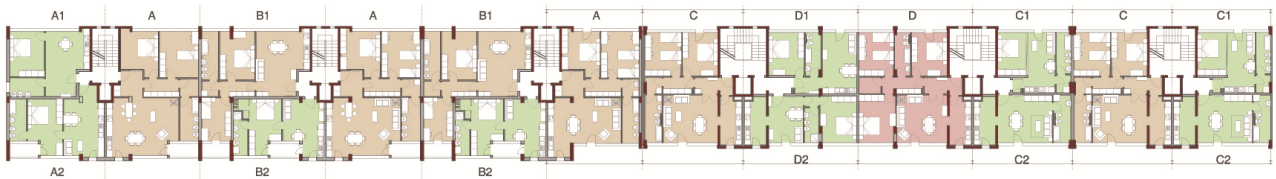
Pianta piano tipo - ipotesi di progetto.
